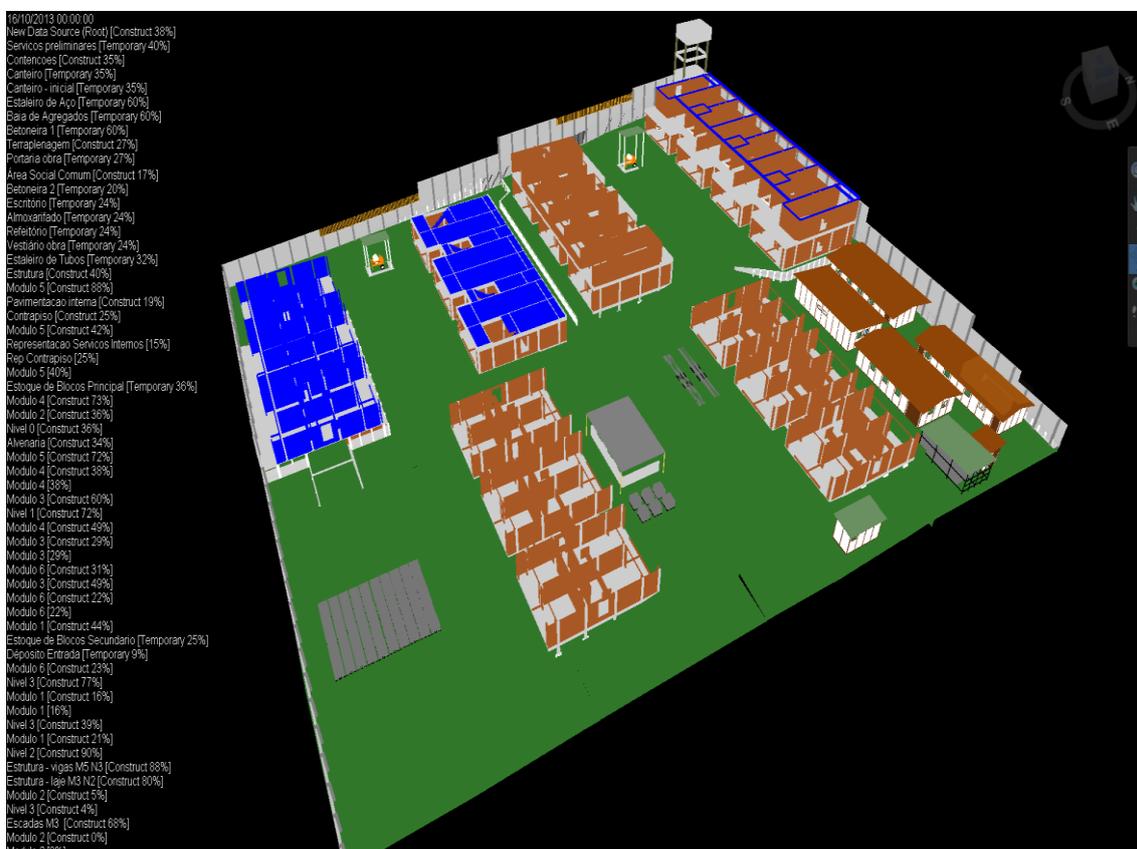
Planejamento em 16/10/13: estrutura, alvenaria e canteiro
